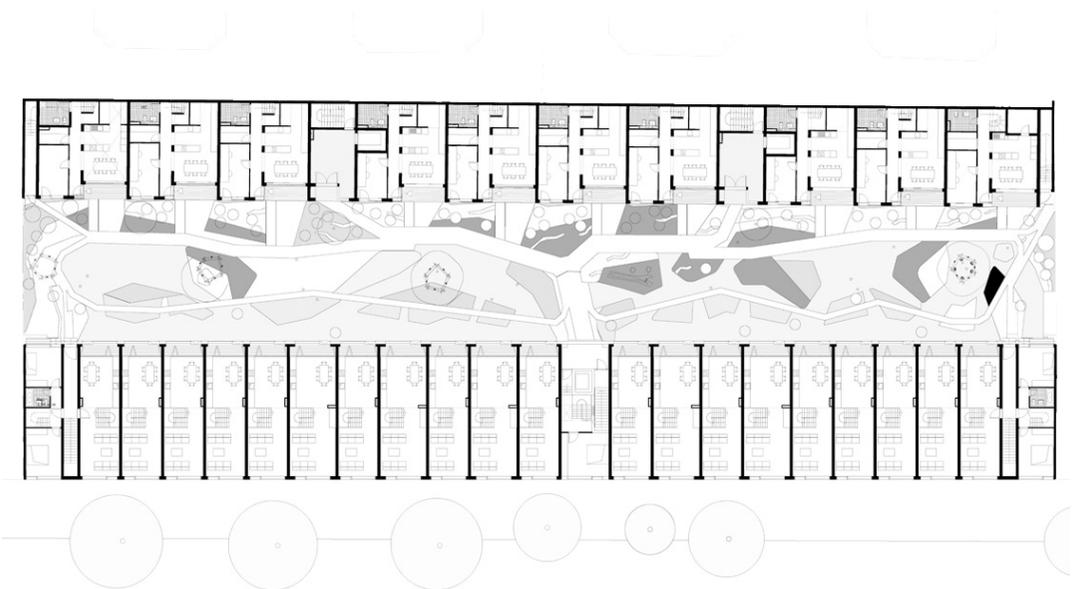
BIGyard, Grundriss gemeinschaftlicher Innenhof
